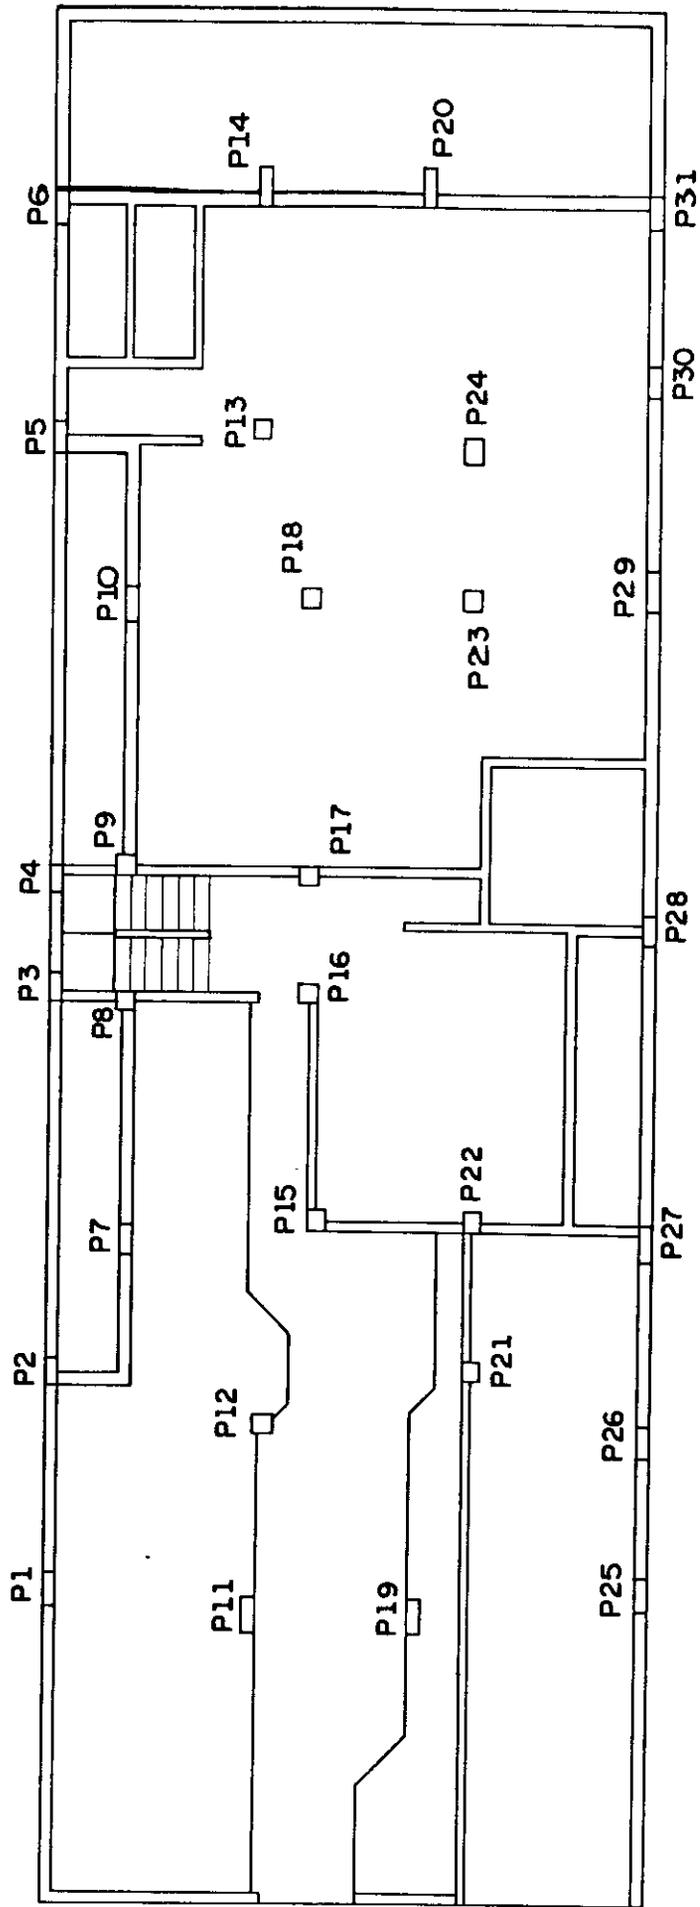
b - Estrutura III - Posicionamento dos Pilares no Pavimento Térreo do Edifício B
